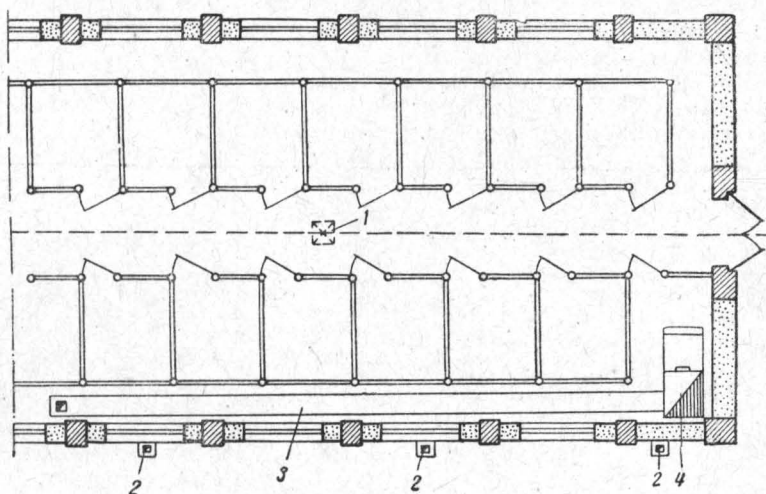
Схема устройства печи с боровым обогревателем для свиарника:
